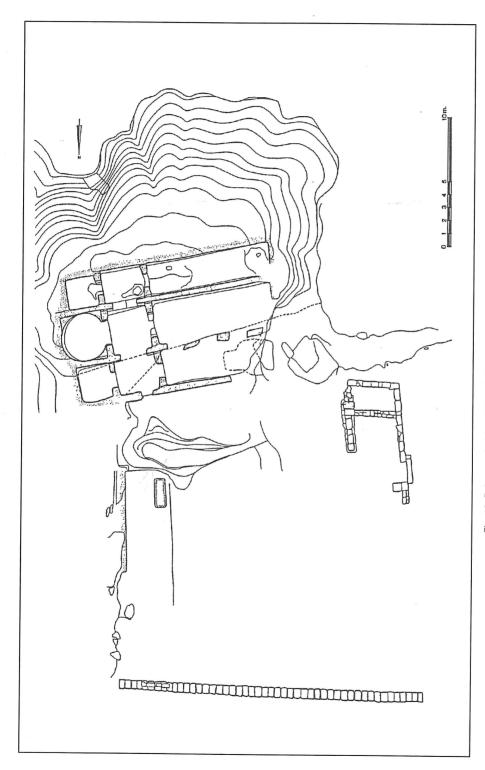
Bobastro. Ardales (Málaga). Planta (según: Puertas Tricas)
